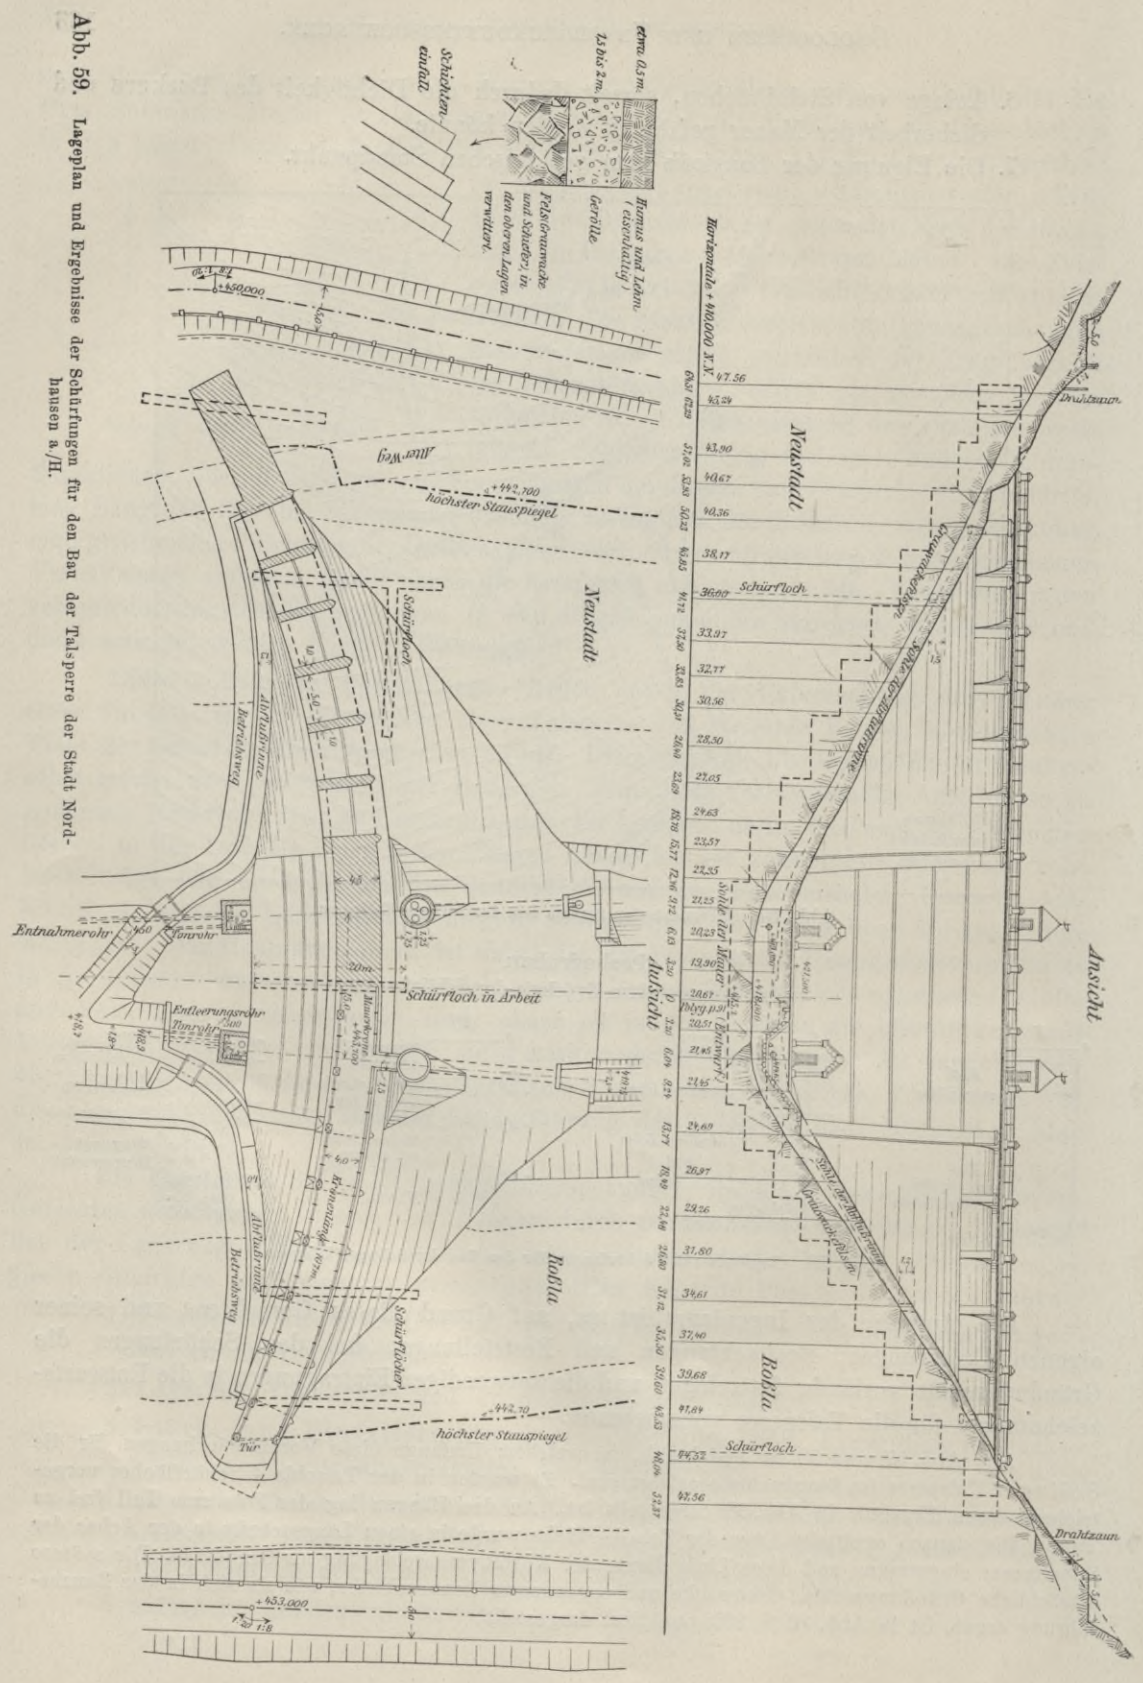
Lageplan und Ergebnisse der Bohrungen für den Bau der Talsperrre der Stadt Nordhausen a/H.
